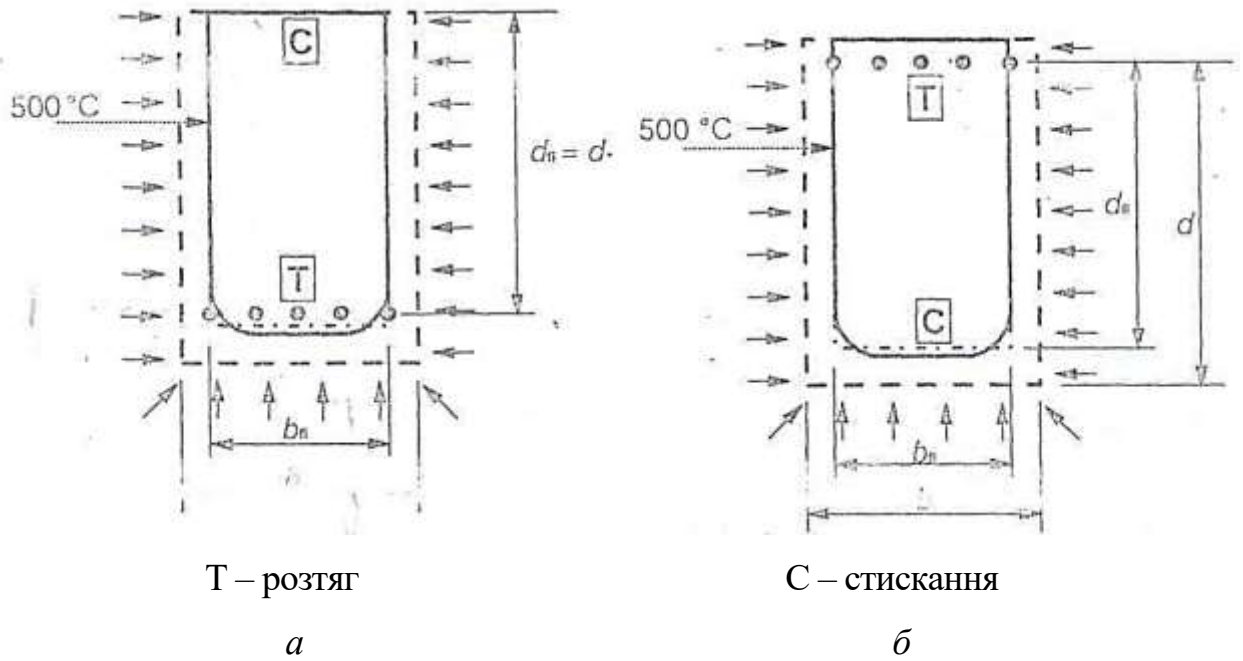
Зразок поперечного перерізу залізобетонної балки або ригеля:
